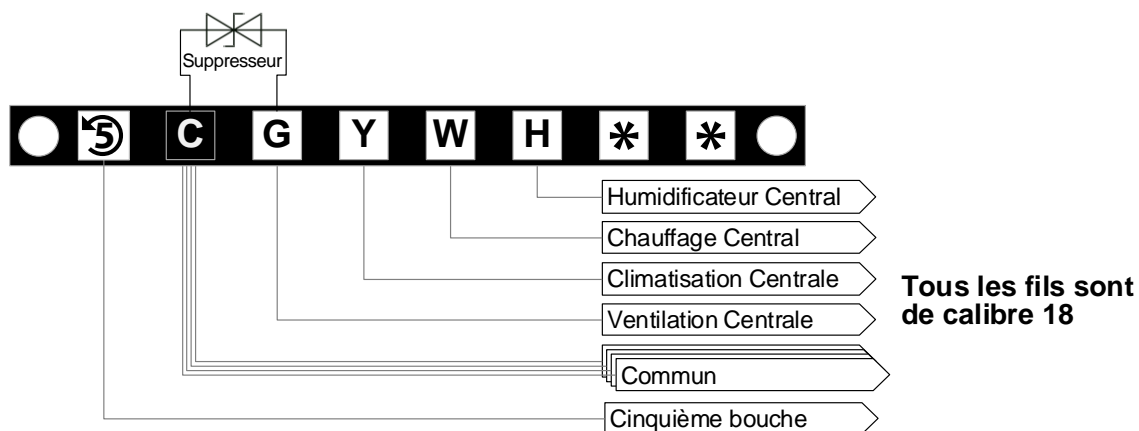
Branchement au ventilateur à air pulsé et autres appareils centraux.
